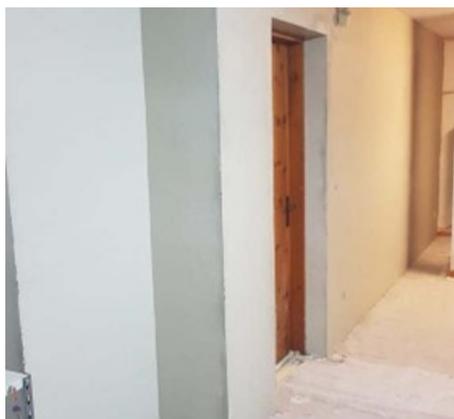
Fasi di isolamento delle pareti verticali e della copertura civile inclinata
